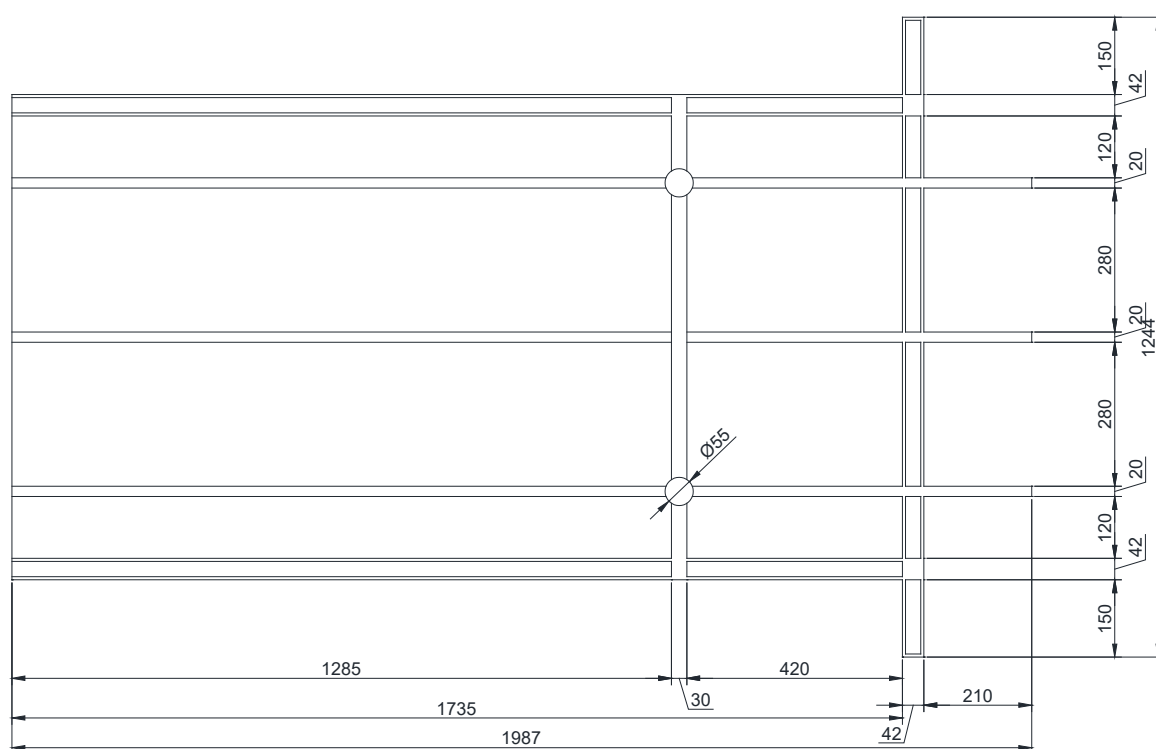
Implantação das áreas em concreto armado. *Fonte: O Autor.
